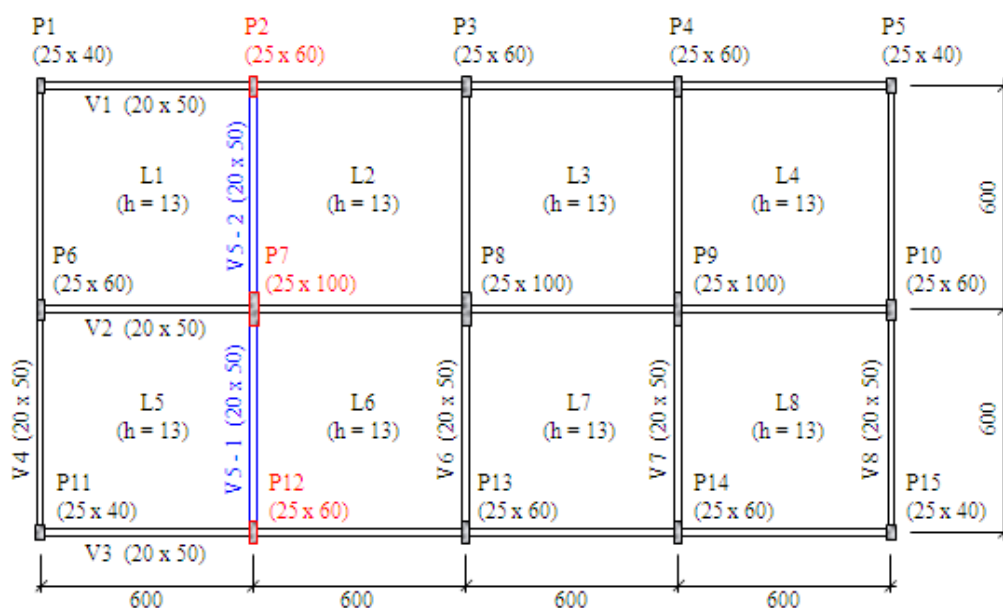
Planta de formas estruturais do pavimento-tipo do edifício comercial.
